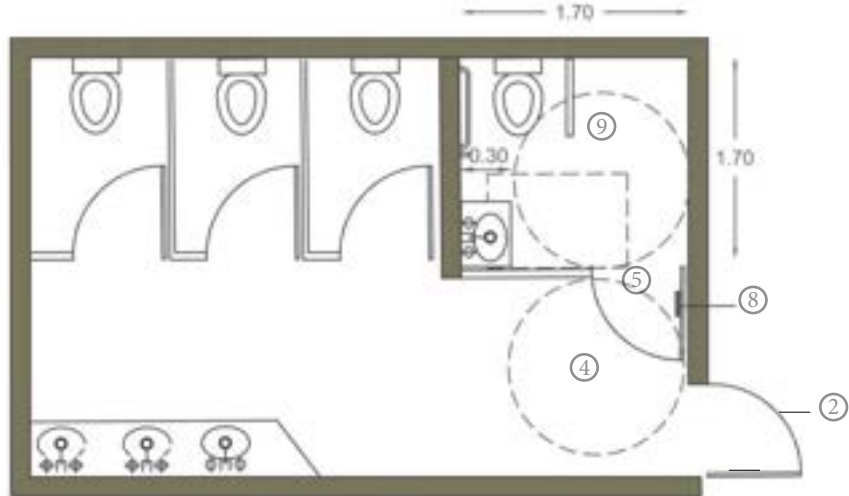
2 Sanitario general con cubículo con lavabo - Planta
